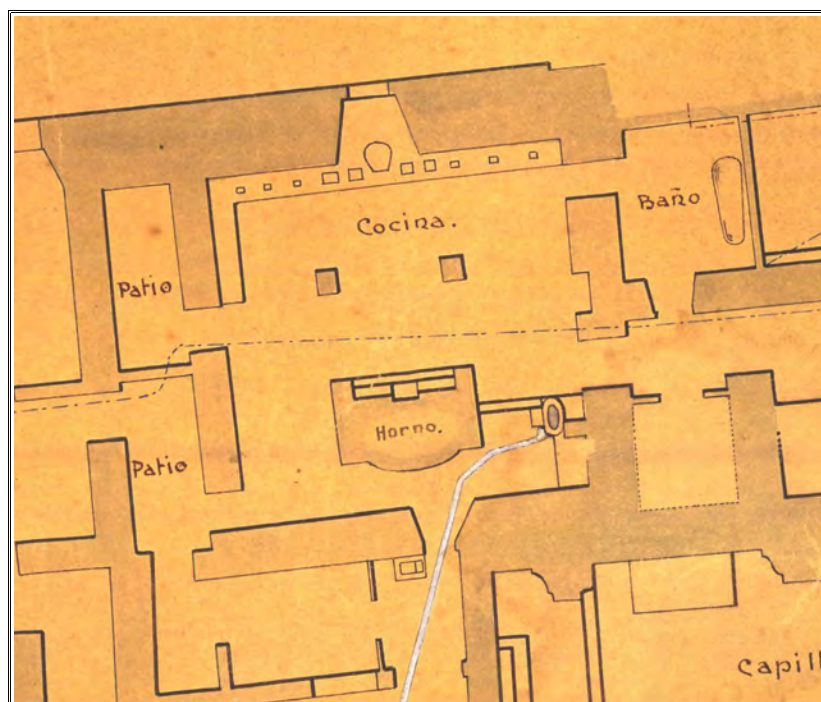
Detalle de la cocina y horno en el plano de Félix Caballero, 1920.
